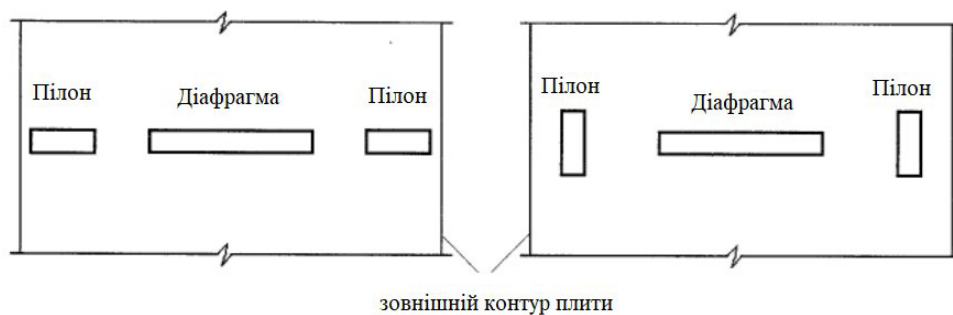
Схеми розташування вертикальних конструкцій на плані
